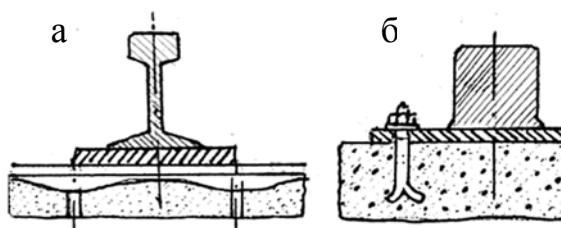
Неподвижное крепление рельса подкрановой балки:
